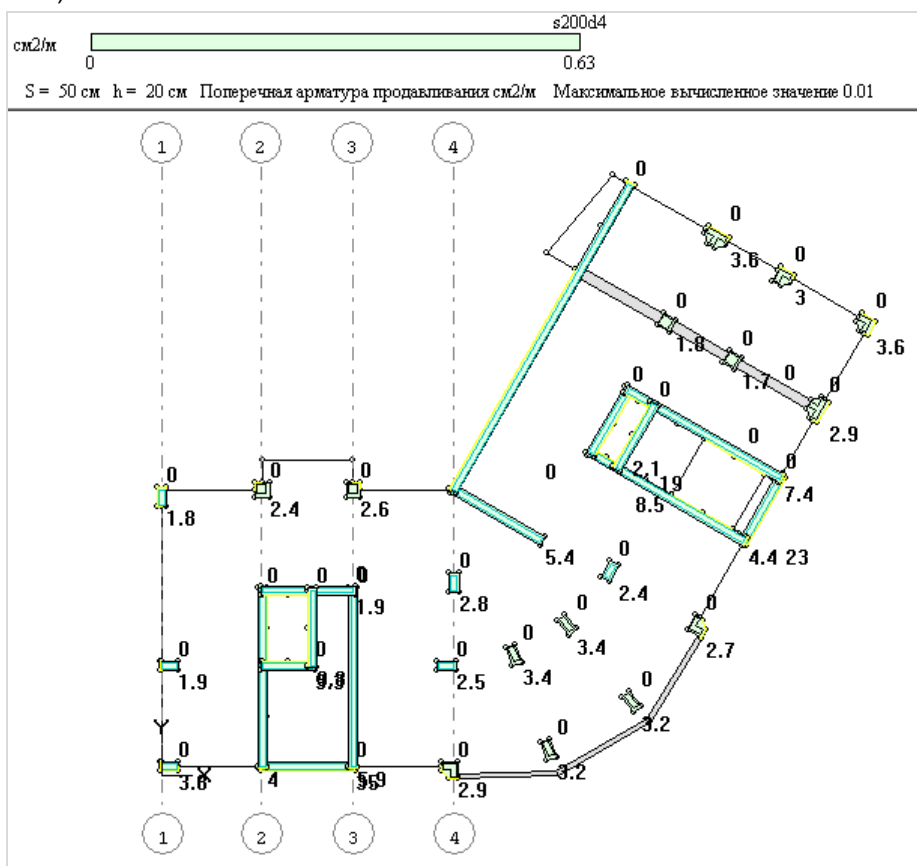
Площадь поперечной арматуры продавливания и коэффициент запаса
